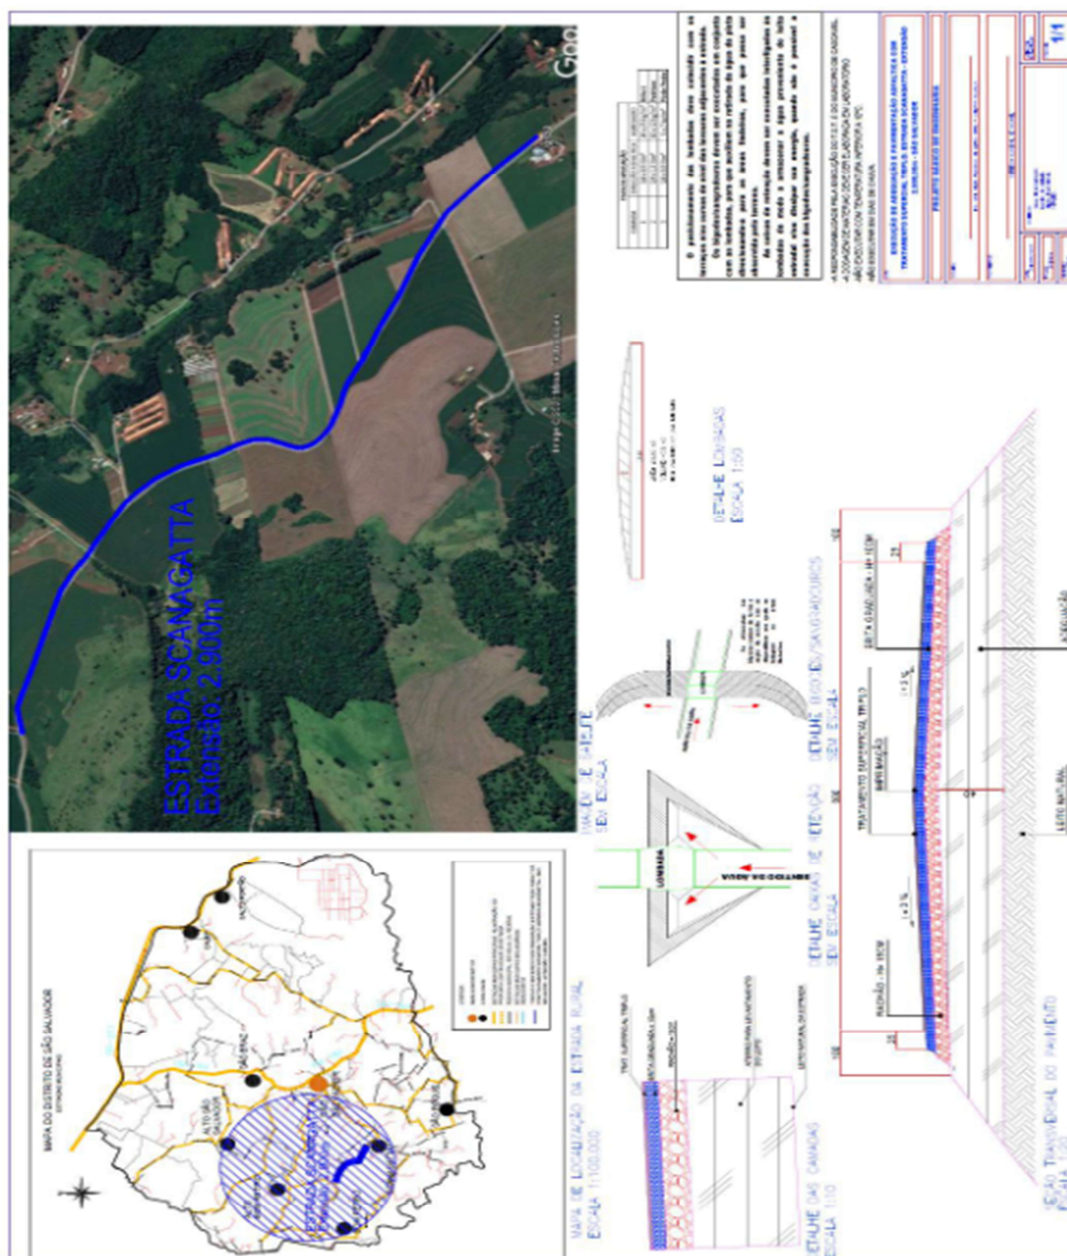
Modelo exemplo de projeto gráfico para Pavimento
